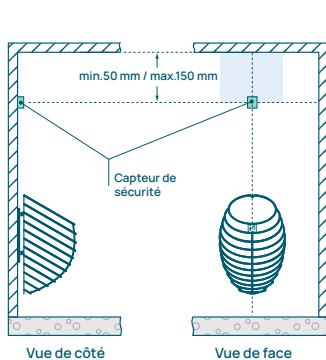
Installation du capteur de sécurité sur le mur : chauffage mural
